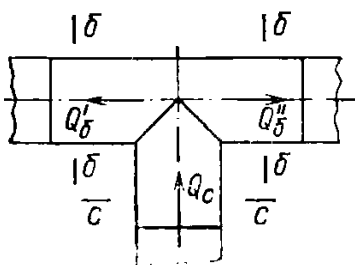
Тройники сварные. Разделение на расходящиеся противоположные потоки
